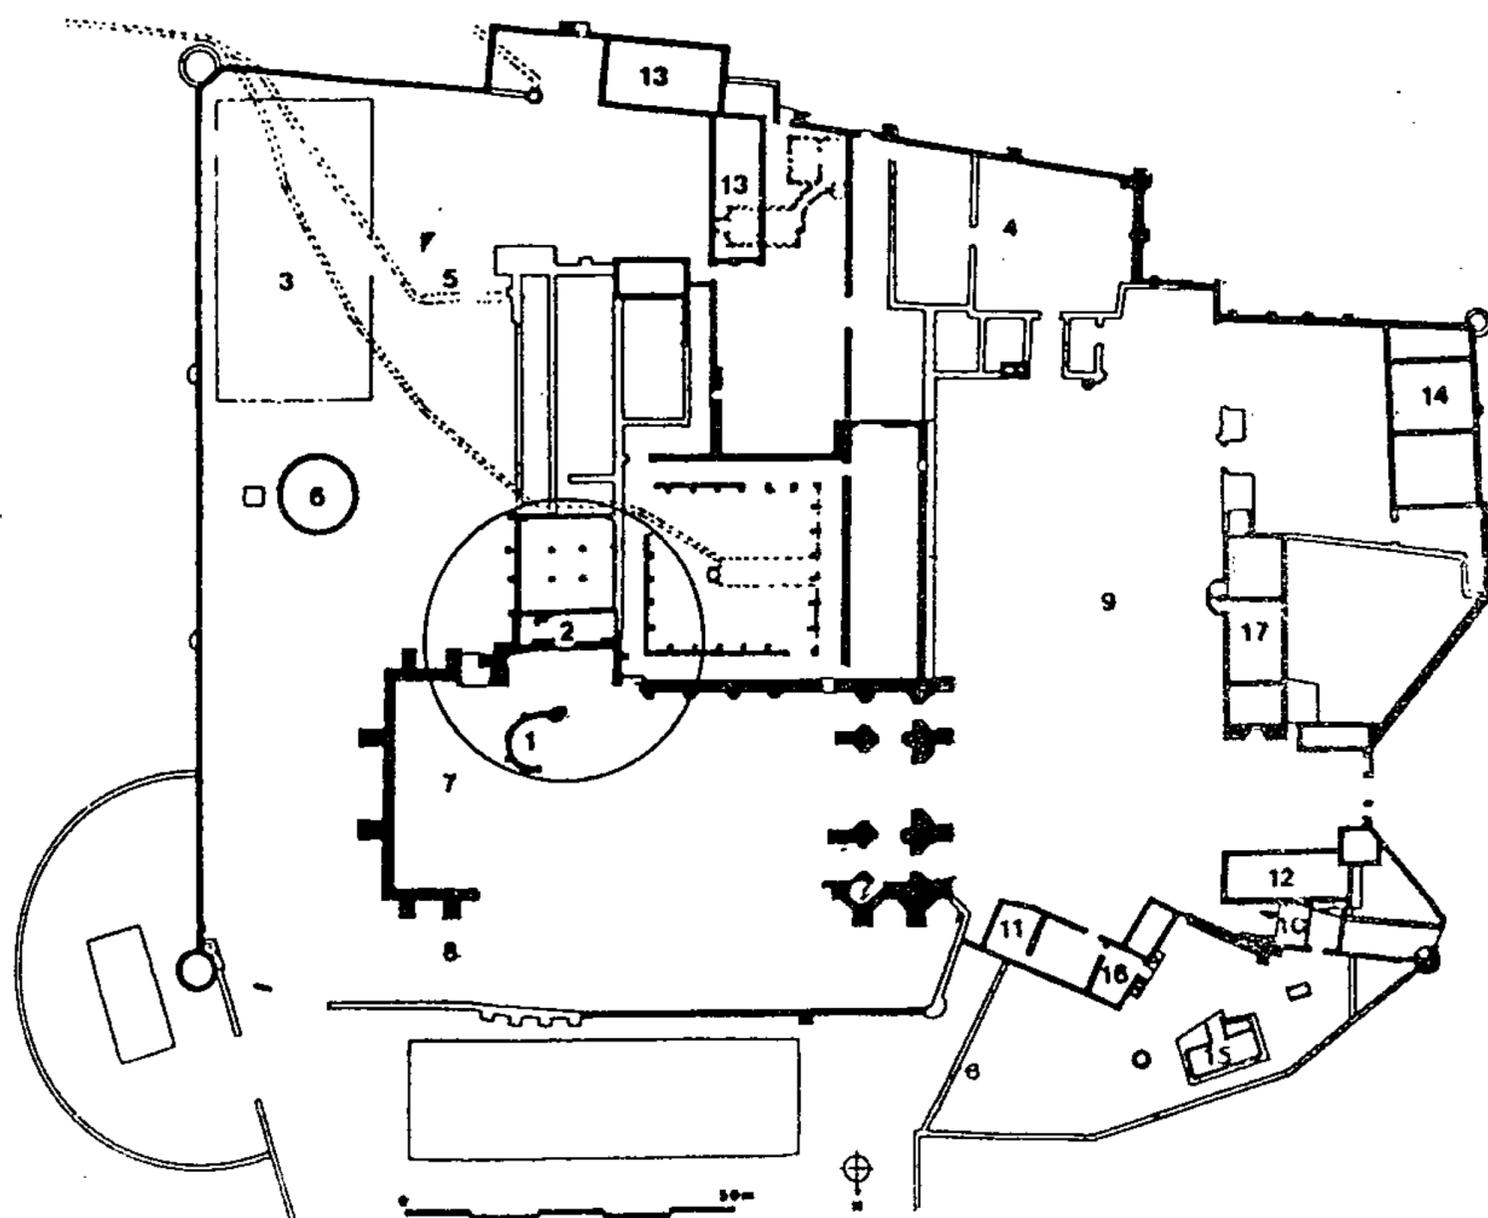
Soissons, Saint-Jean-des-Vignes : plan général du site.
